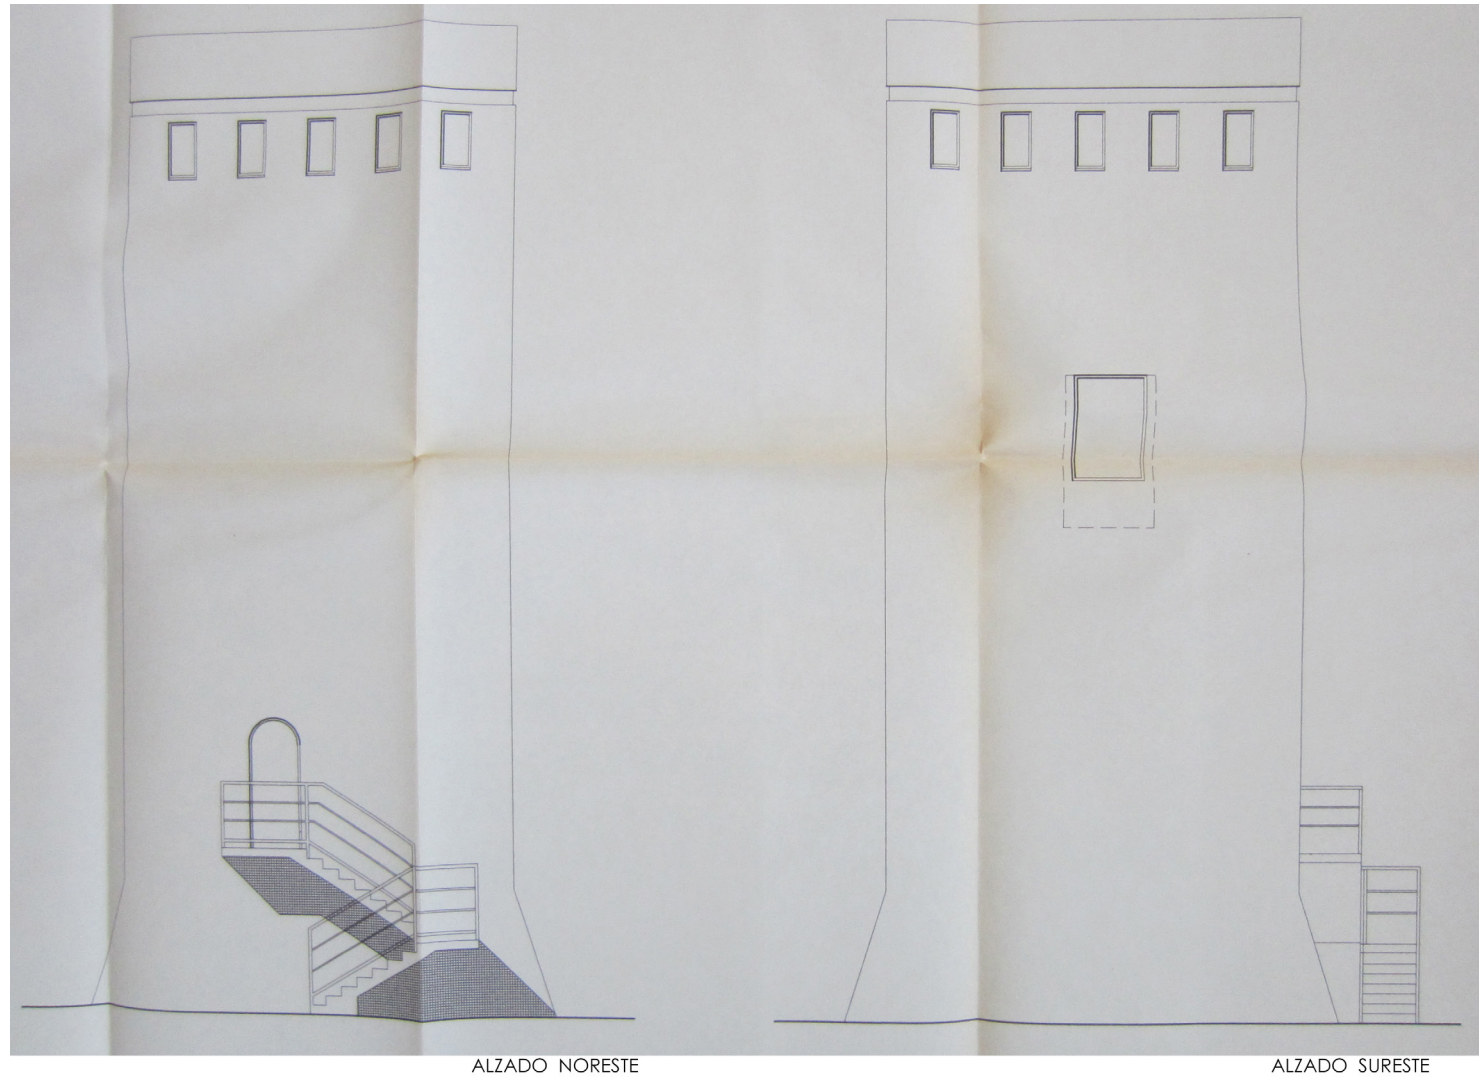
Vista de los alzados Noreste y Sureste.
